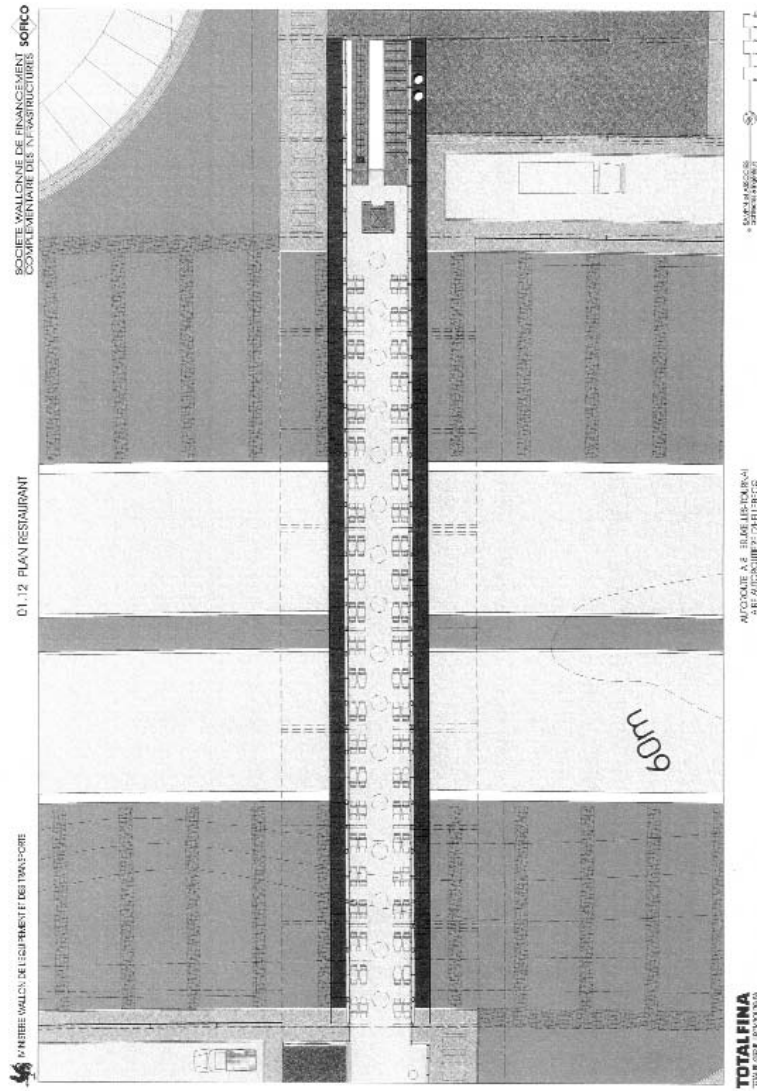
Pianta del piano ristorante (Samyn & partners)
